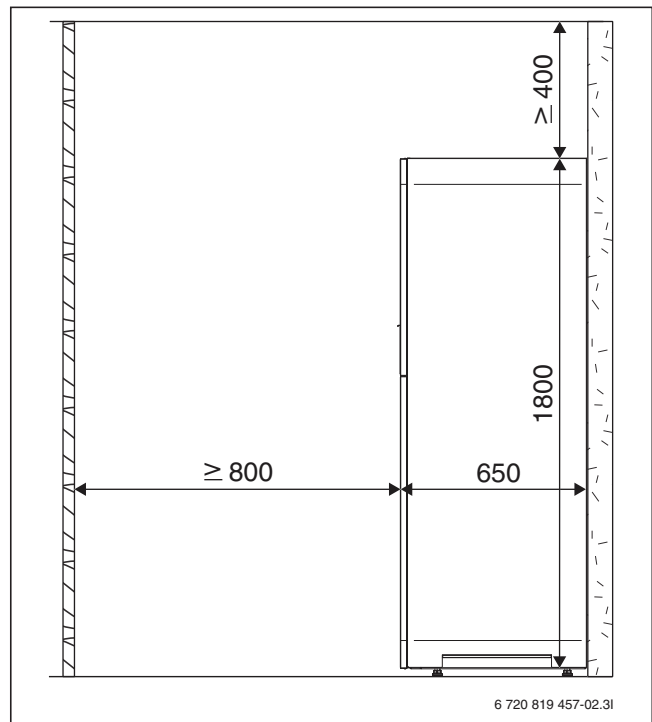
Mindestabstände des Towers, Seitenansicht (Maße in mm)
